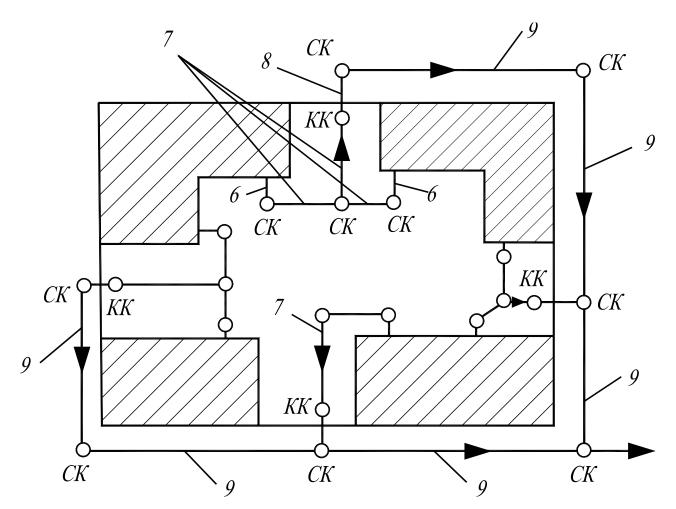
Схема внутриквартальной водоотводящей сети:
